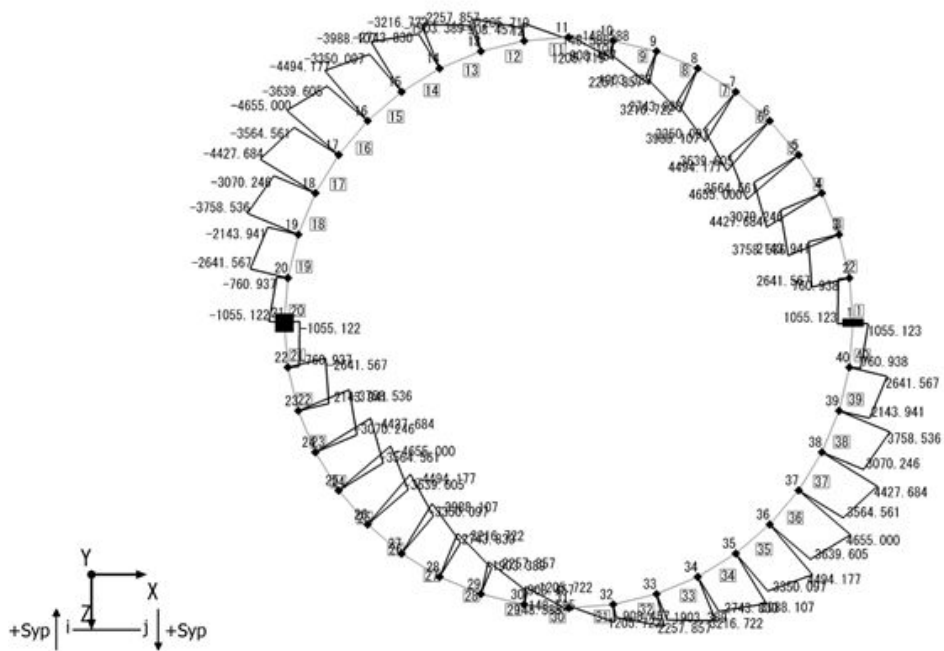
(3) コンクリート及び鉄筋の曲げ軸力が最も厳しい時刻の断面力
